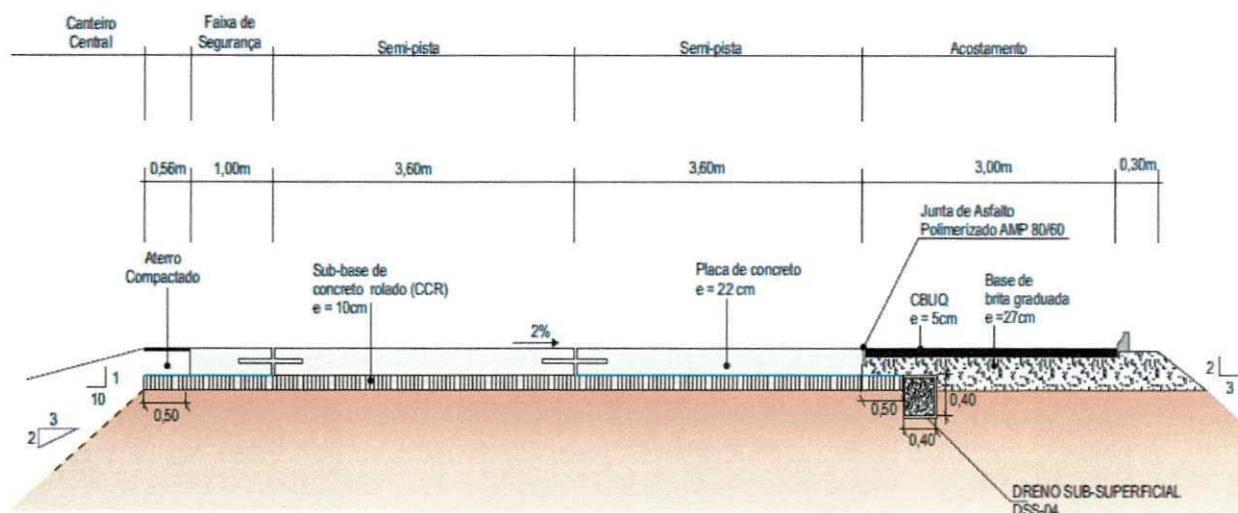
Detalhe do pavimento tipo rígido em projeto.
